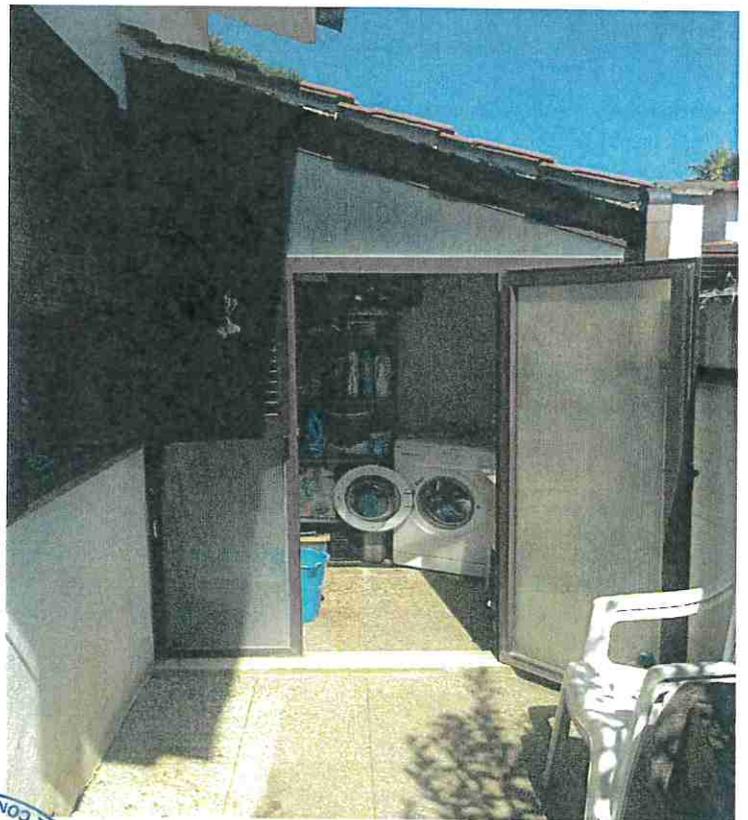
LOCALE ACCESSORIO REALIZZATO IN CORRISPONDENZA DEL PROSPETTO POSTERIORE SENZA TITOLO ABILITATIVO PERTANTO NON SANABILE
